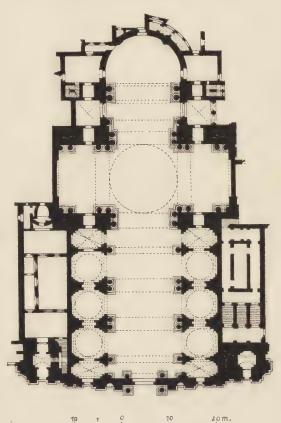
Theatinerkirche zu München. Grundriss.
